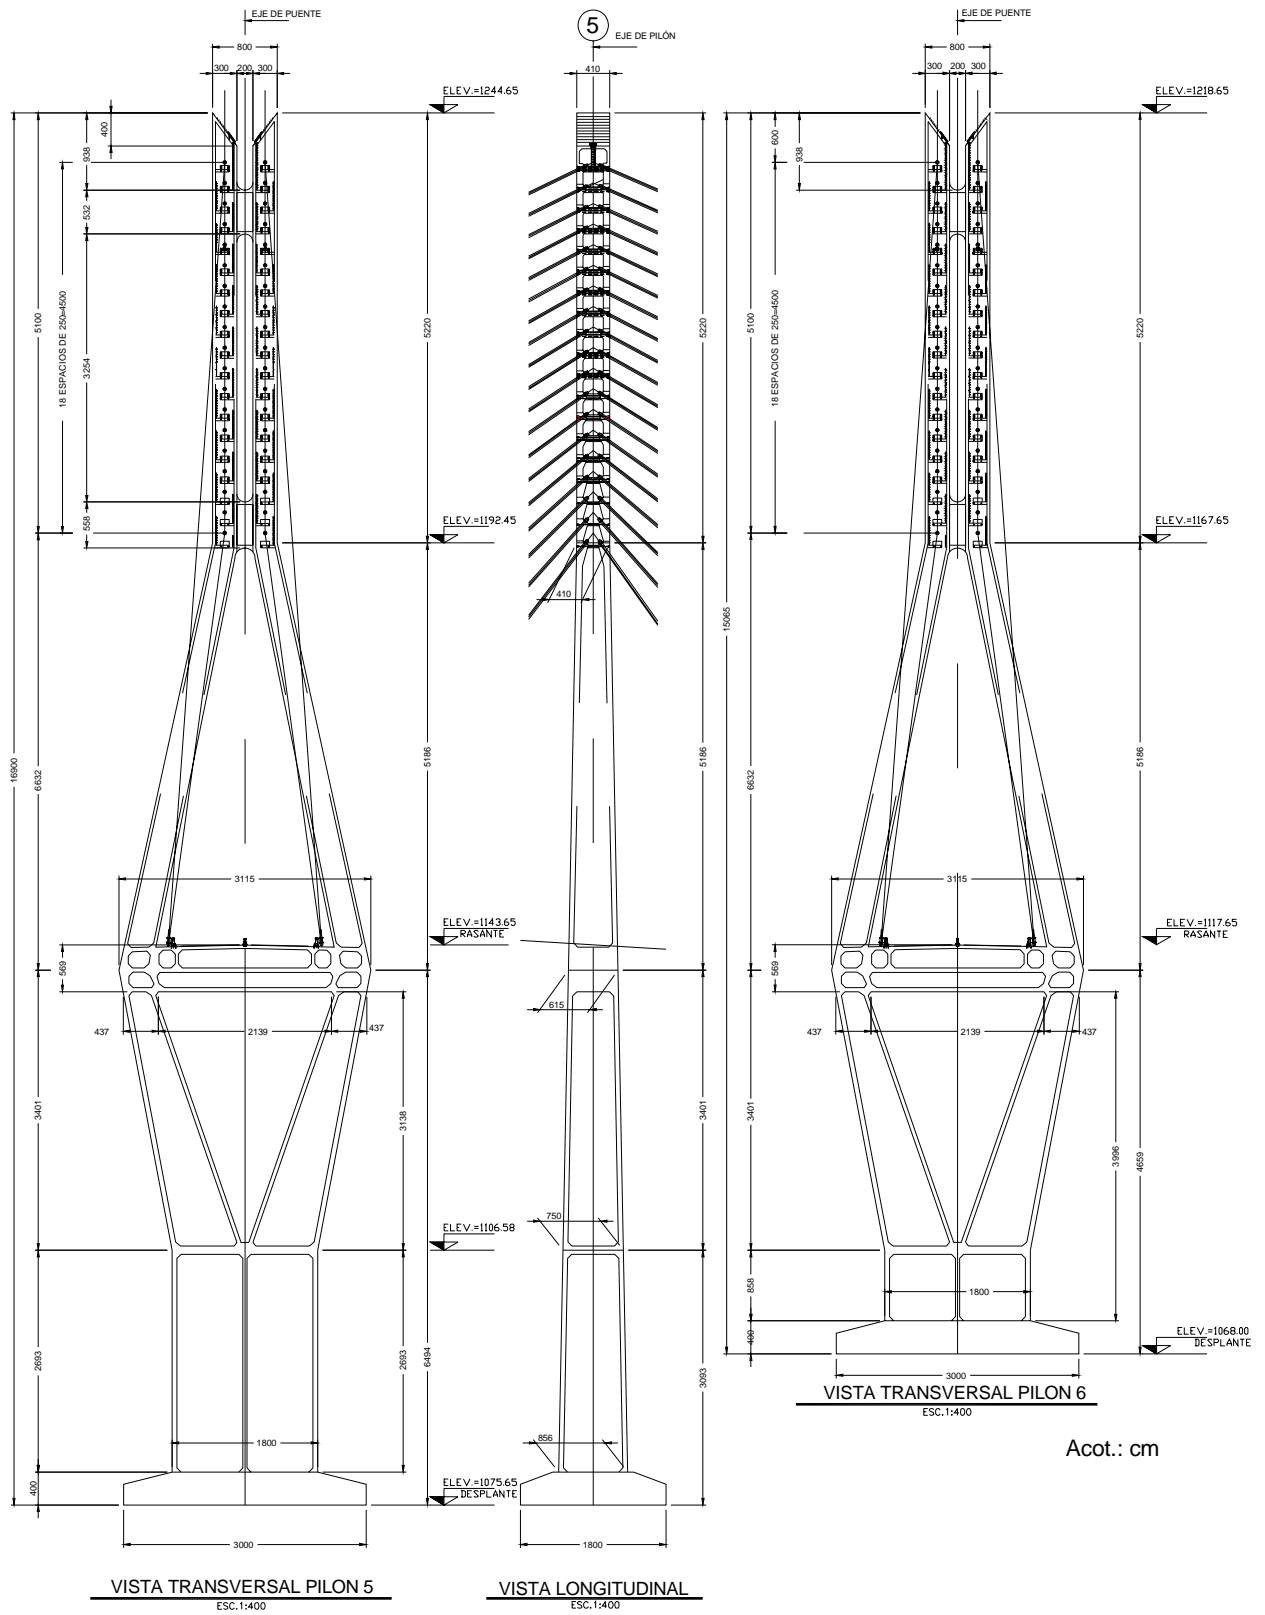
Vista general en alzado de los pilones 5 y 6
